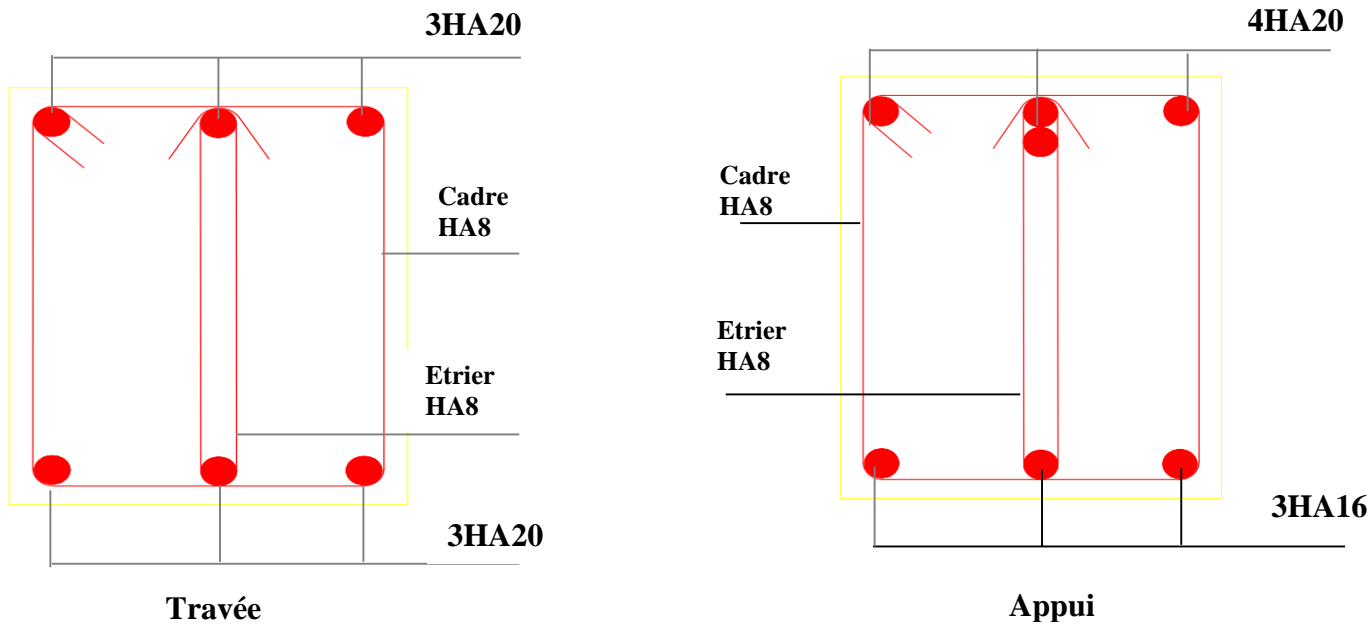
Schéma de ferrailage poutres principales E.sol et S.sol, RDC
